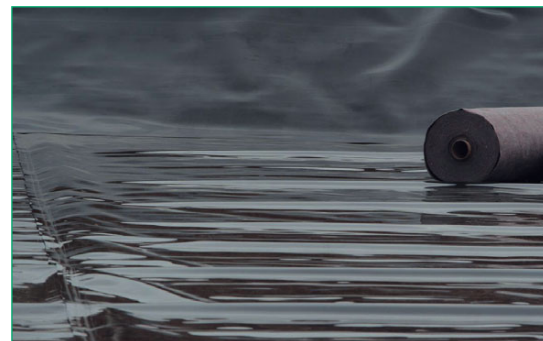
Geomembrana soldada Carbofol® (Allmannsweier, Alemania).
